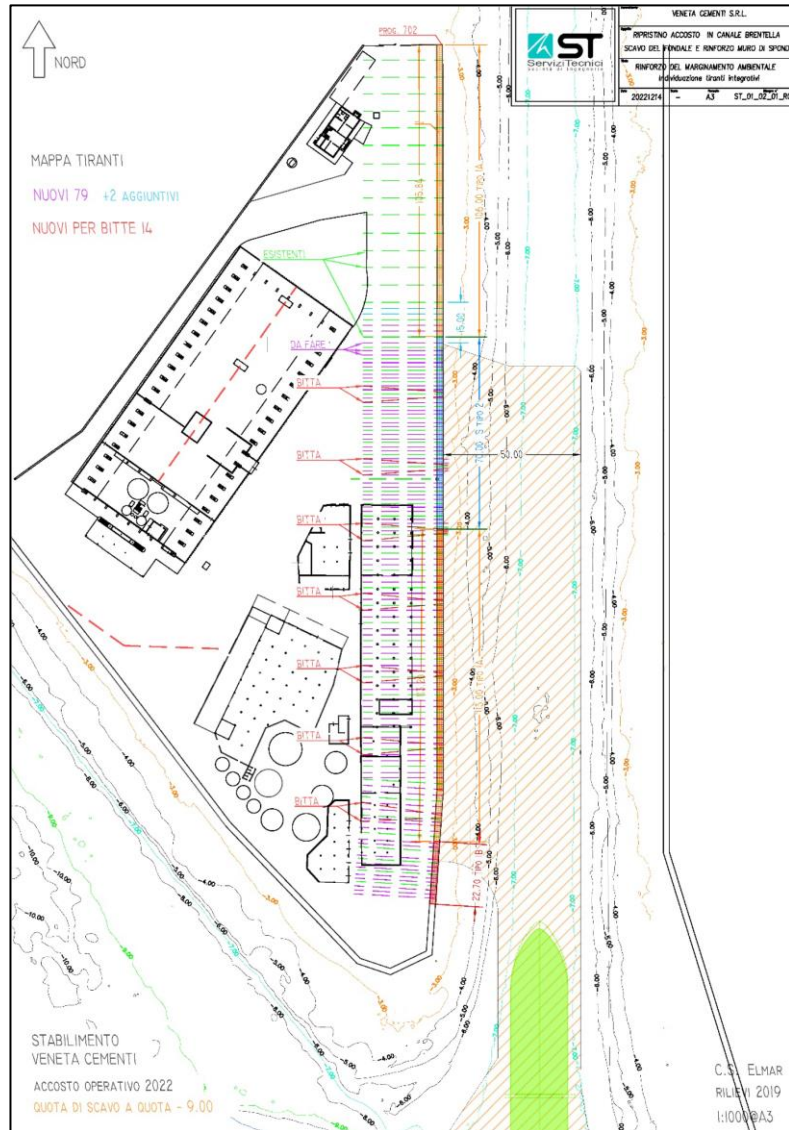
Planimetria dragaggi e rinforzi muro di sponda Canale Industriale Brentella. Fonte Progetto Veneta Cementi.
